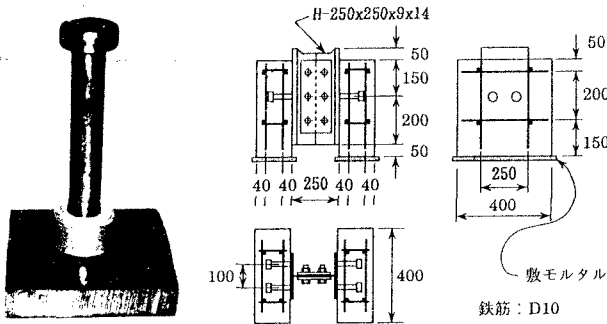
ウレタン付きスタッド 図-1 押抜き試験体の形状寸法
